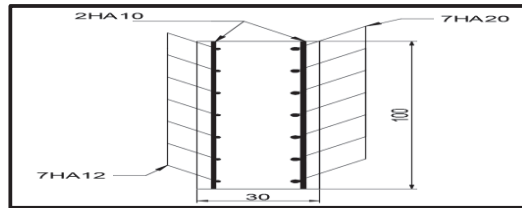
Vue en plan du ferrailage de mur garde grève
